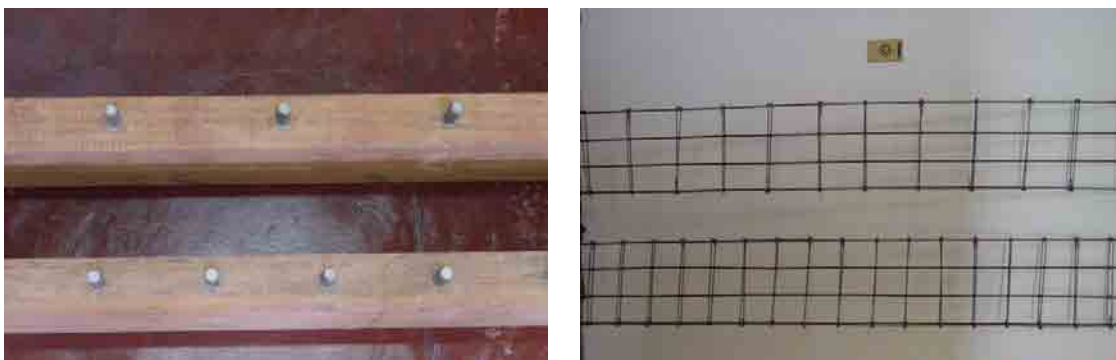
Pinos perpendiculares e armaduras da mesa de concreto
